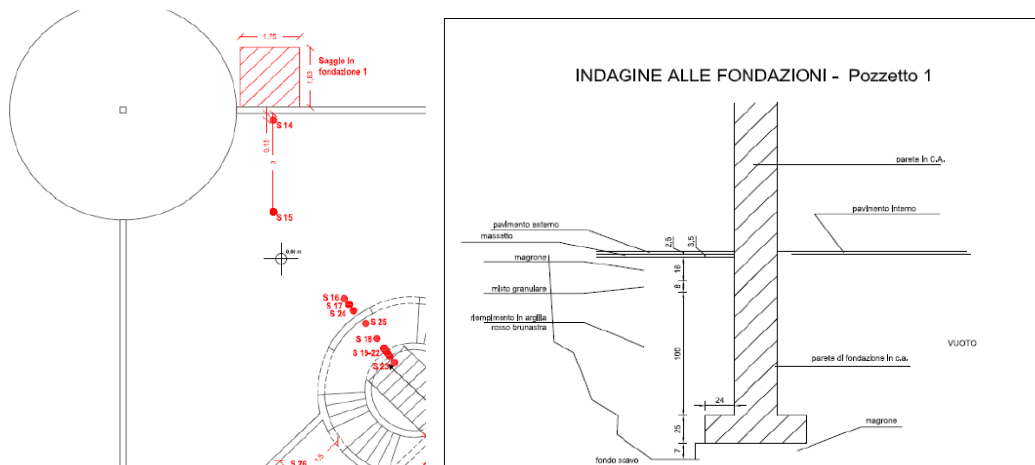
ubicazione planimetrica e schema del pozzetto 1
